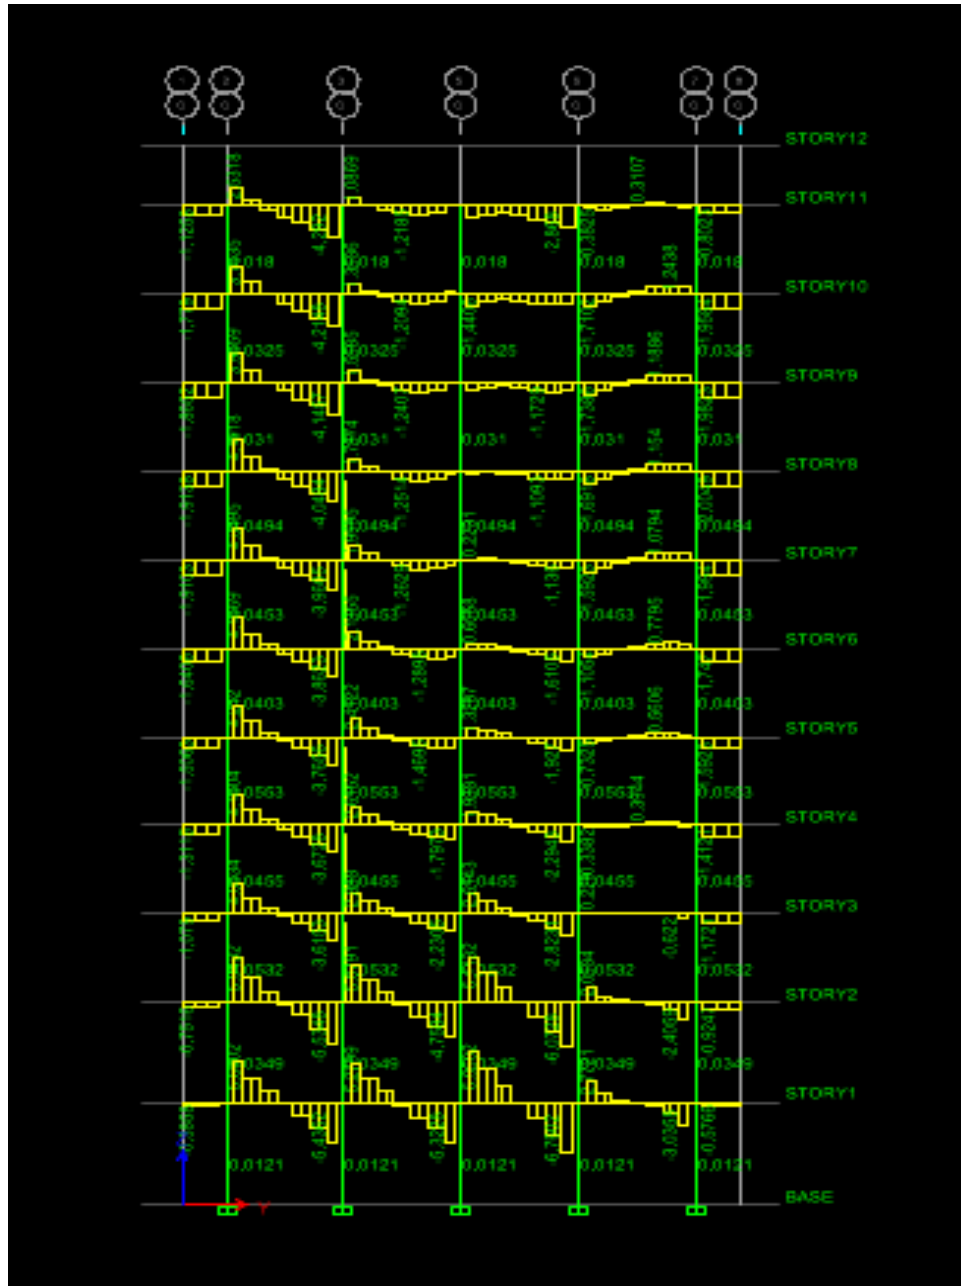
Exemple de la torsion aux des poutres, axe2
